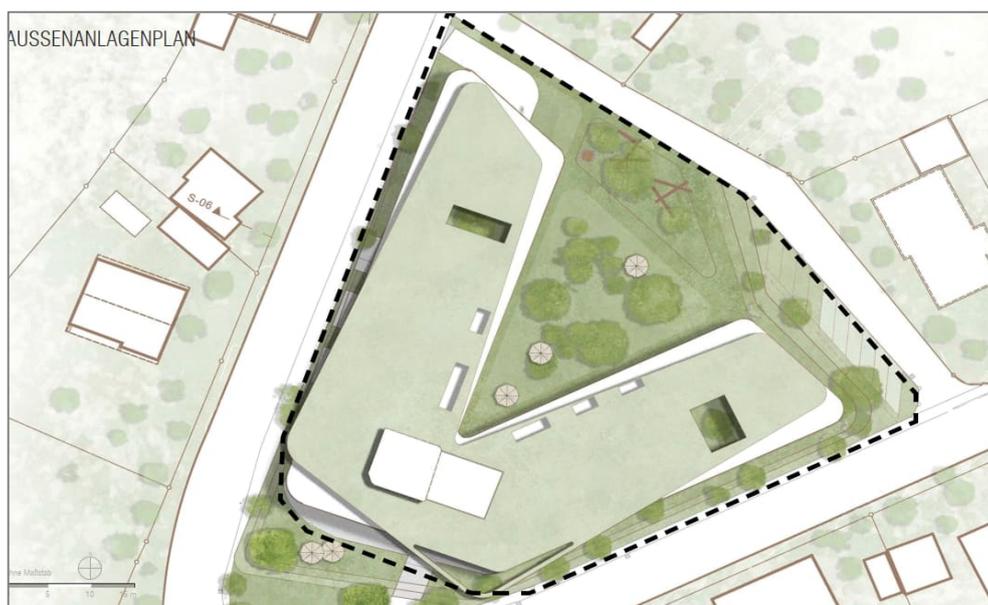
Vorhaben- und Erschließungsplan (Außenanlagenplan)
